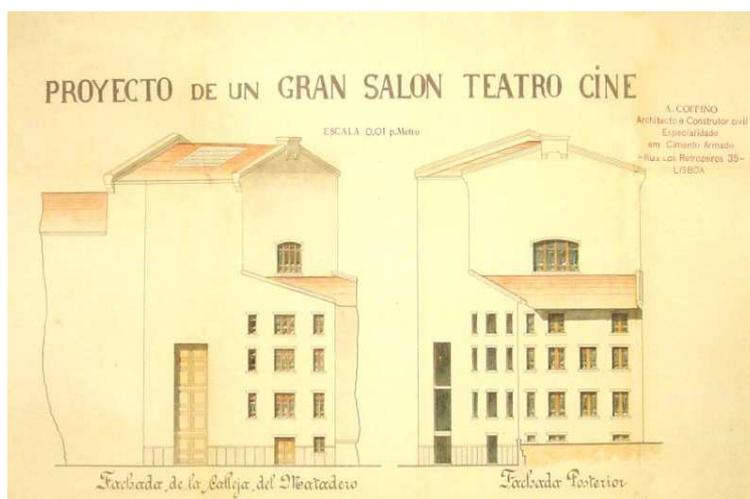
Plano alzado principal y plano fachada de la Calle matadero, fachada posterior (COFFINO, A.: *Proyecto*, 1913) [LÓPEZ BERNAL, V.]
